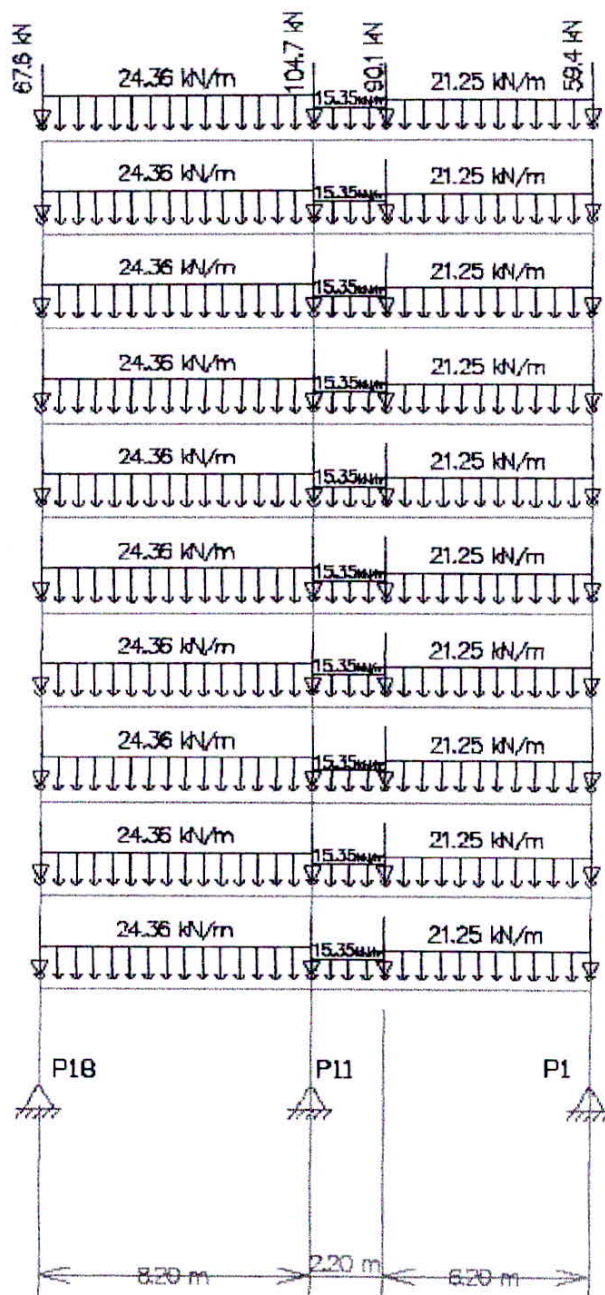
Pórtico P11 transversal, carregamentos finais.
